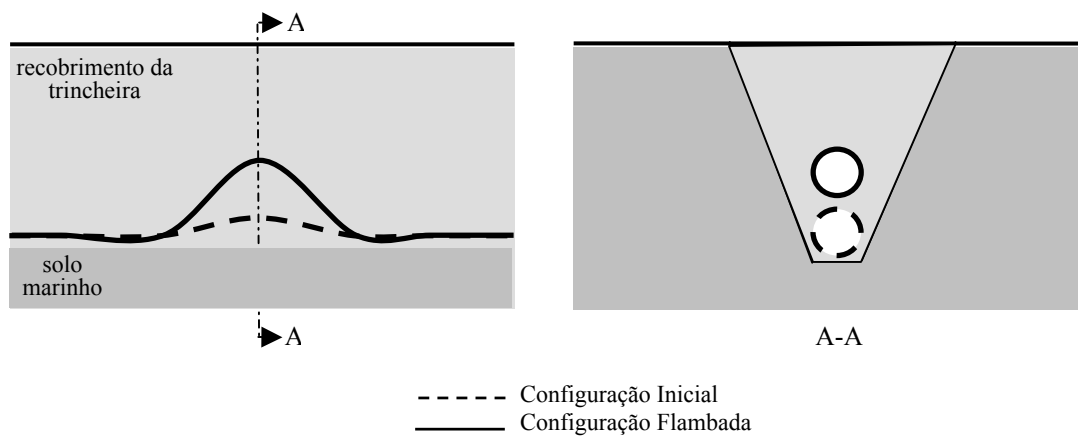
Configuração Esquemática de um Duto Enterrado.
